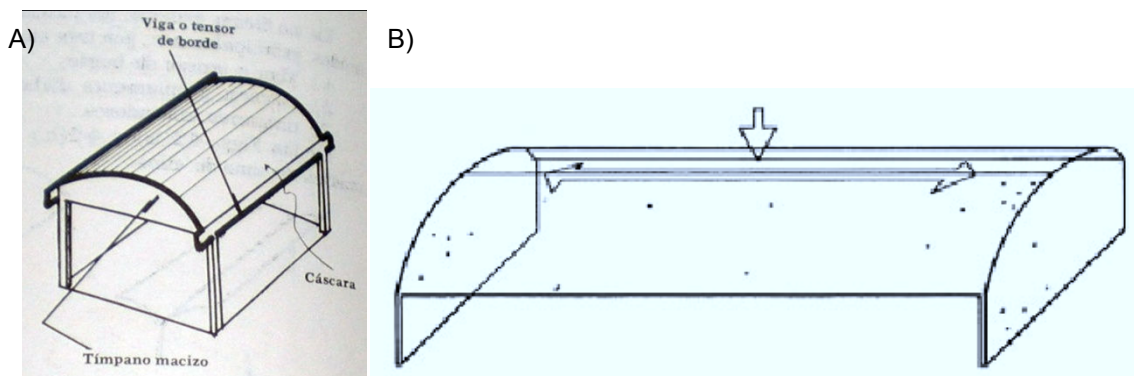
A) Apoyo sobre viga rígida; B) Apoyo sobre muro. (10) y (16)
